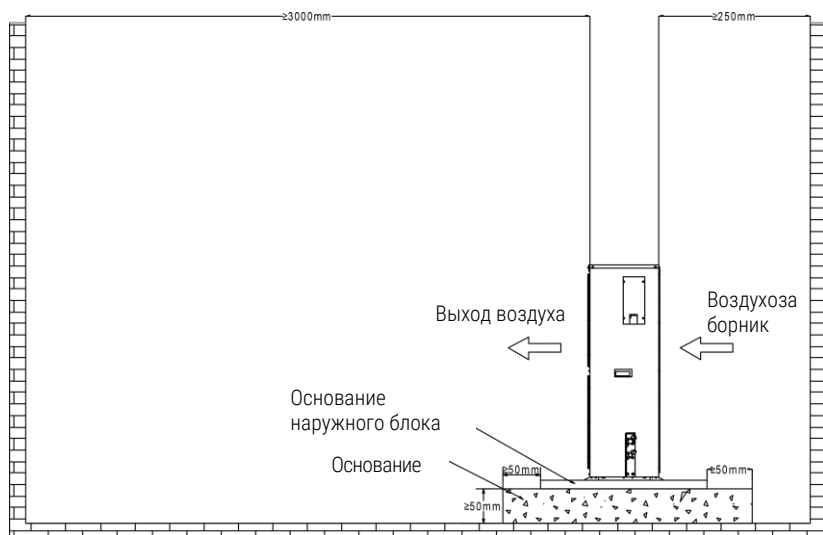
Принципиальная схема перекрытия и установки наружного блока мощностью 5 кВт
